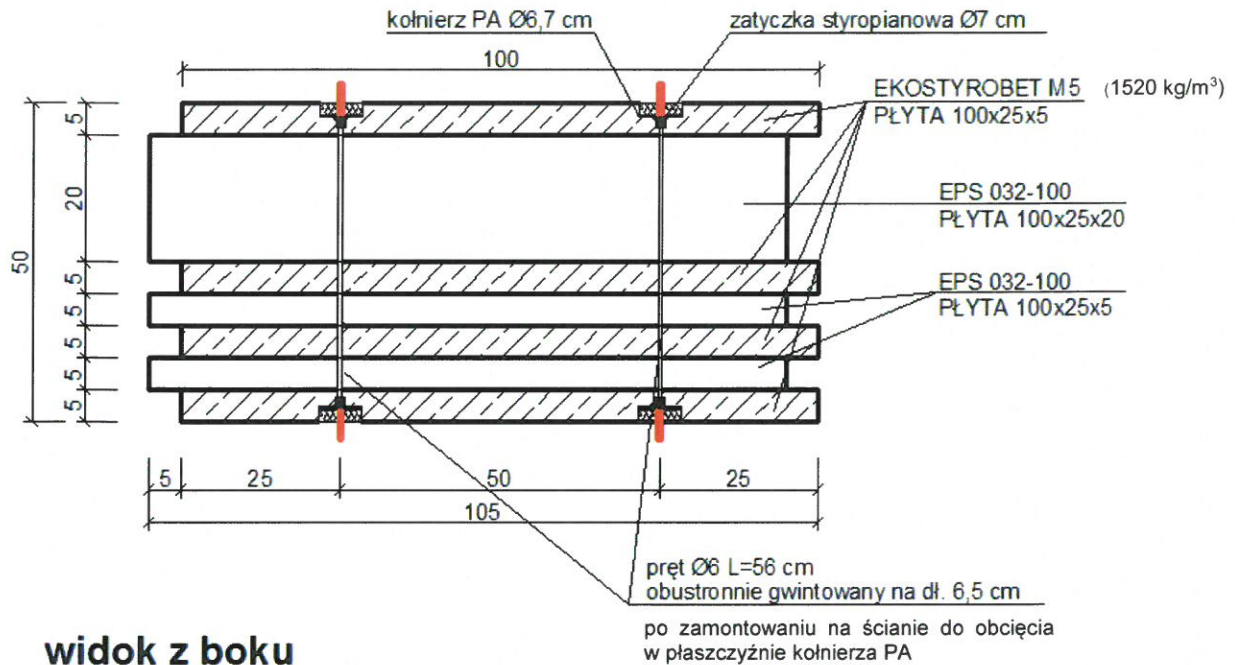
Wielkoblokowy element murowy EKOBLOK - półkrowy, poprzeczny
